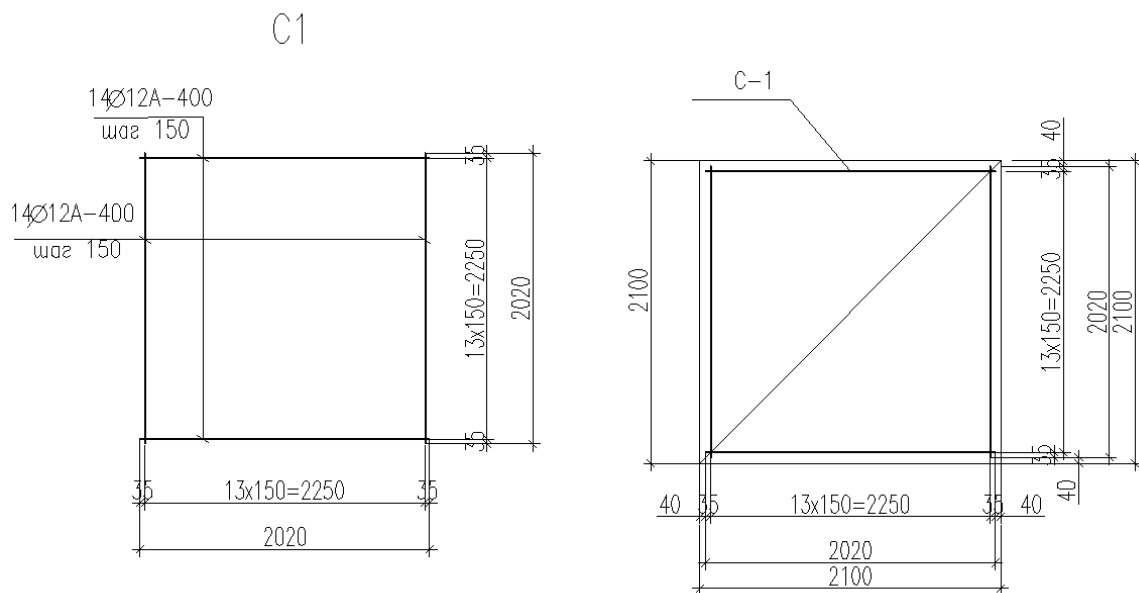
Схема армирования подошвы свайного фундамента. Арматурная сетка С-1.
